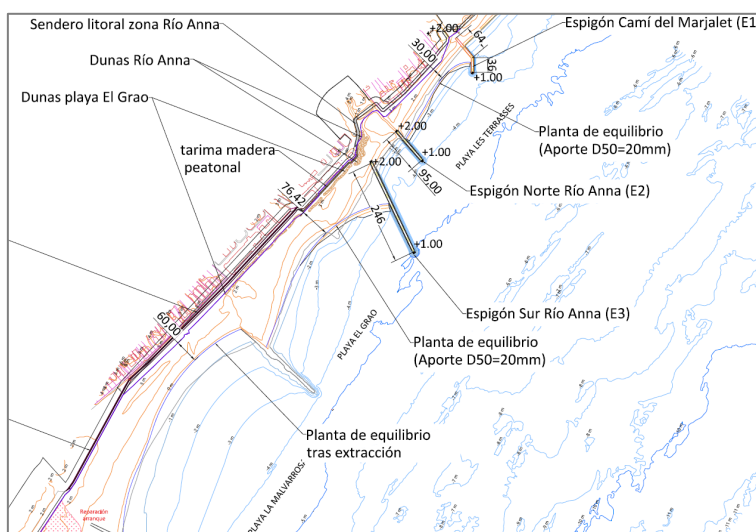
Forma en planta de las playas tras la actuación y estructuras de defensa costeras proyectadas.
